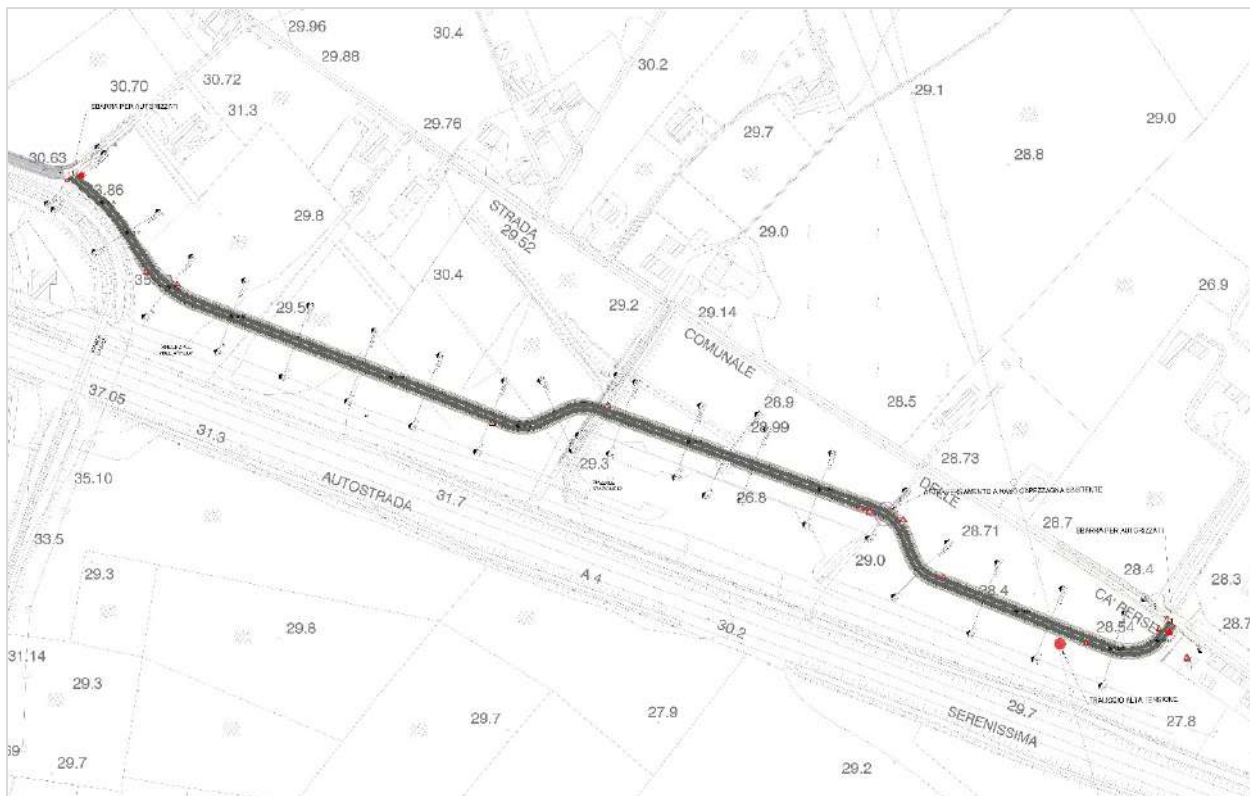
Estratto progettuale: bretella stradale quadro di unione.
